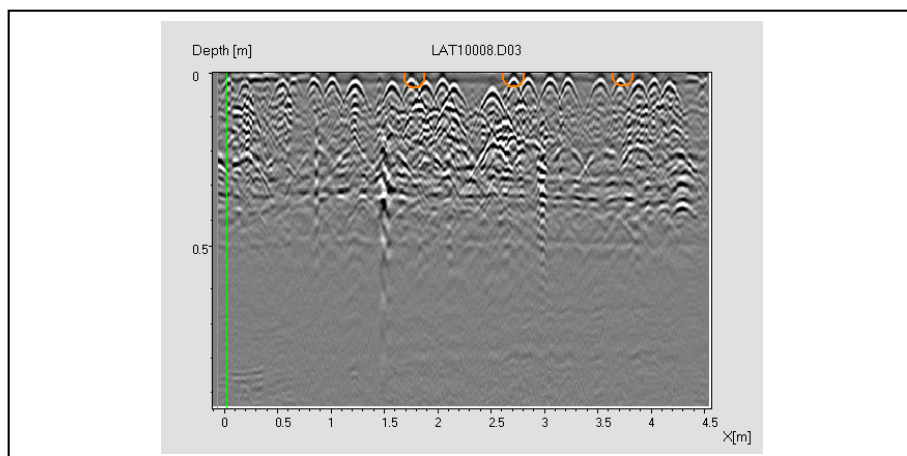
SEZIONE LONGITUDINALE (PARALLELA ALL'ASSE DEL CANALE) LAT10008
